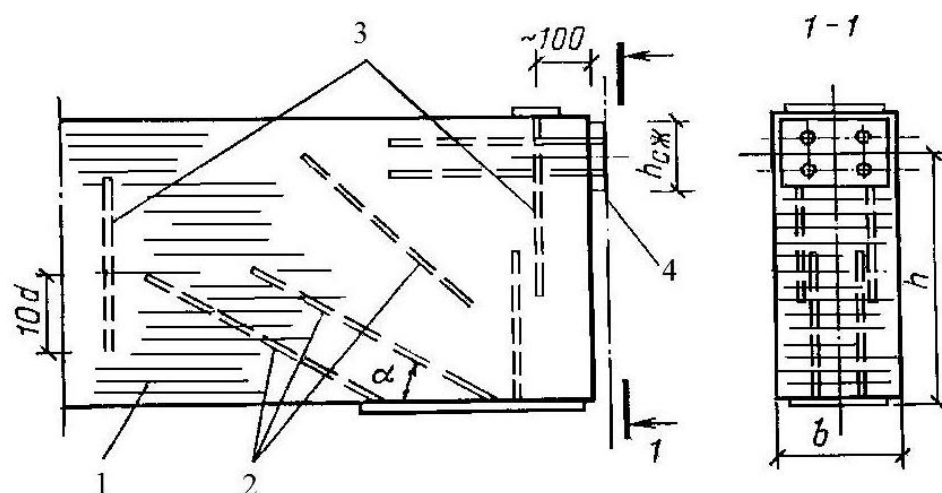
Схема жесткого несимметричного стыка на наклонных клеенных стержнях для изгибаемой конструкции: 1 – клееный элемент; 2 – армирование наклонное; 3 – армирование поперечное; 4 – металлическая пластина-прокладка.
